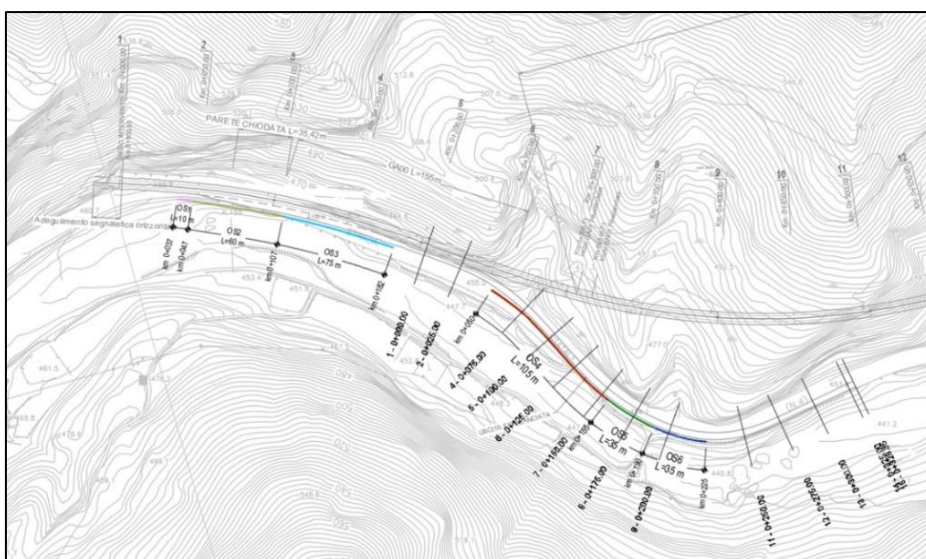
Uscita Favalanziata – ubicazione planimetrica opere secondarie.
